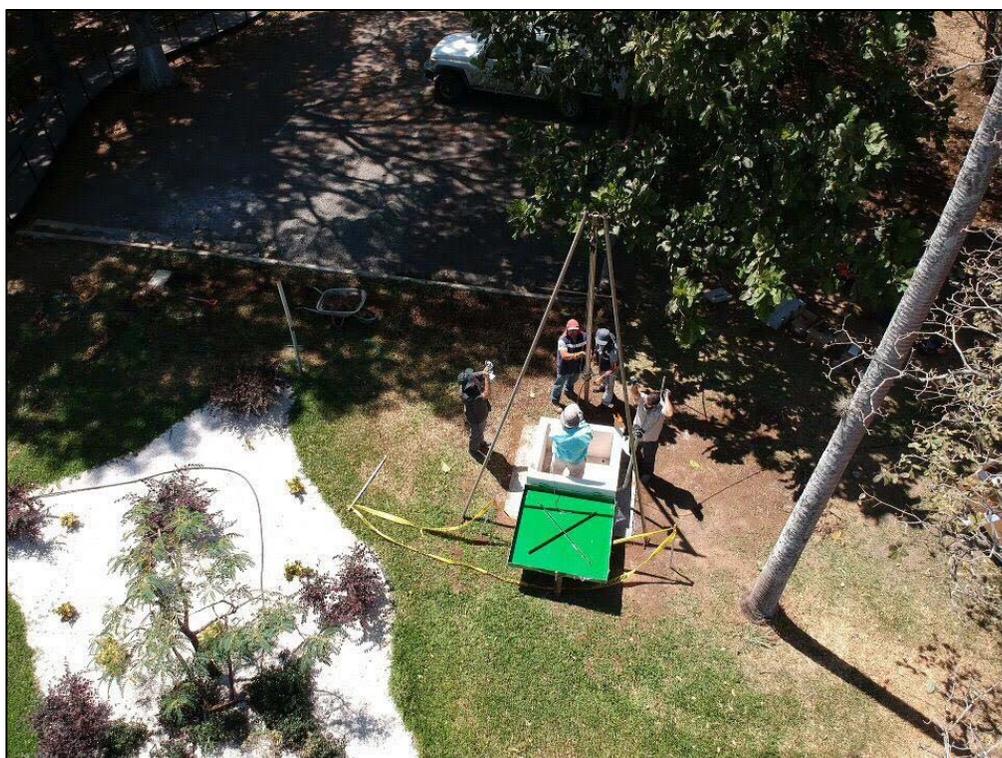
y 10: Identificación y recubrimiento de la instalación eléctrica.
